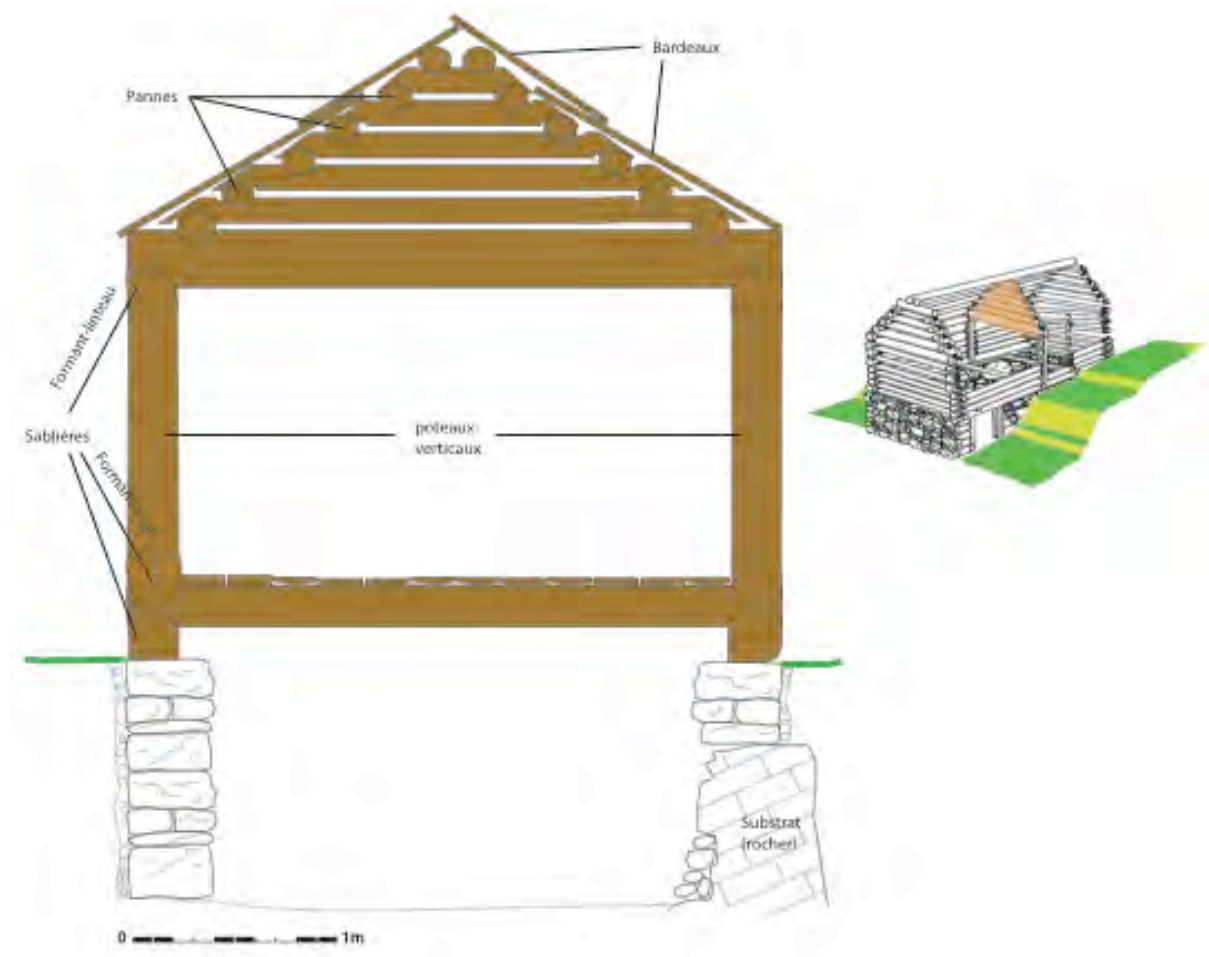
Croquis en coupe au niveau d'un refend-formant-pignon (bâtiment RIO 100). DAO de V.Labbas.
